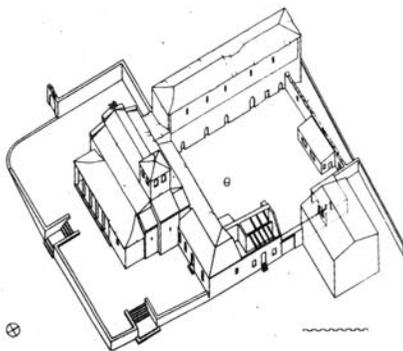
Isometría del Monasterio en 1984. Fig. 6.—Planta del proyecto de restauración. Fig. 7.—Isometría del proyecto de restauración.
